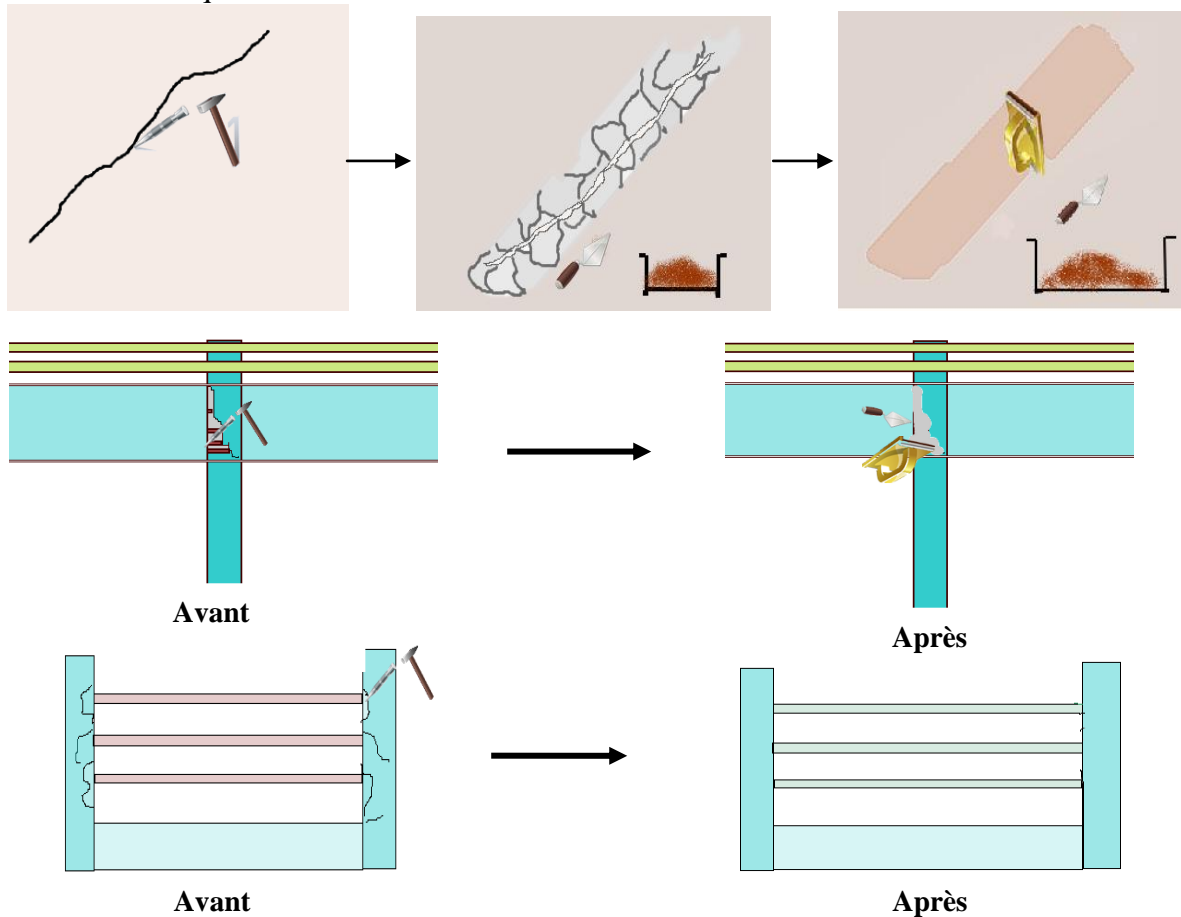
Colmatage des fissures par du mortier du ciment
